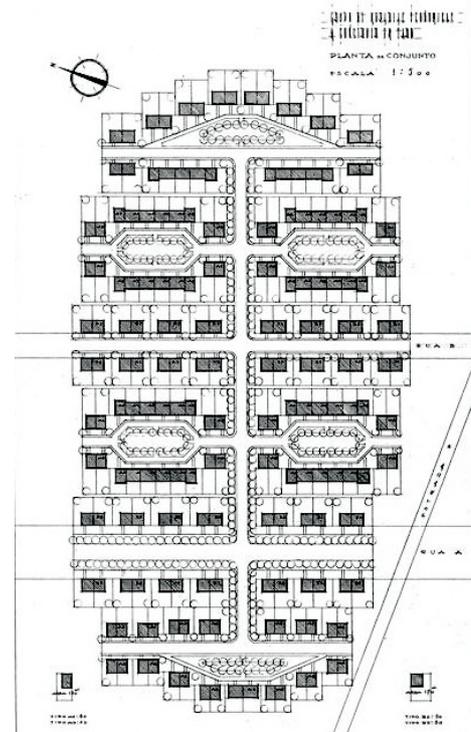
BAIRRO DE CASAS ECONÓMICAS/ BAIRRO DO BOM JOÃO, FARO 1941. PLANTA DE CONJUNTO ESCALA 1:500 S/D. ARQUIVO SIPA/IHRU/DIBA/FORTE DE SACAIVÉM.
